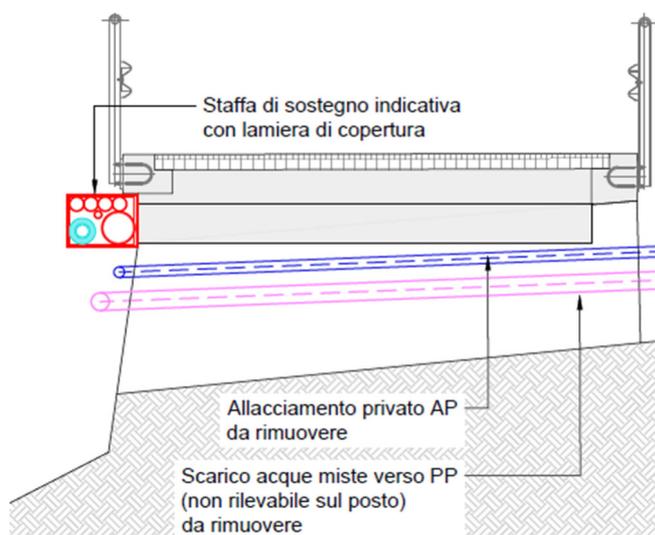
Sezione Tipo F-F, Attraversamento Riale
